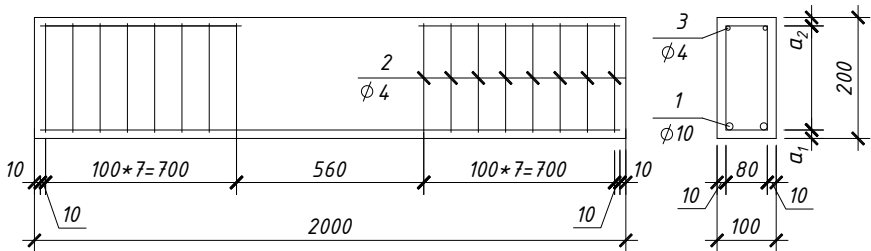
Розміри та схема армування дослідних залізобетонних балок Б
